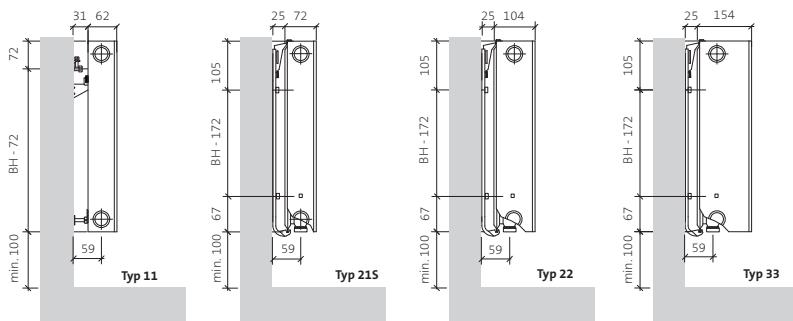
Montagemäße und Anschlusslage Plan Ventil Compact M
